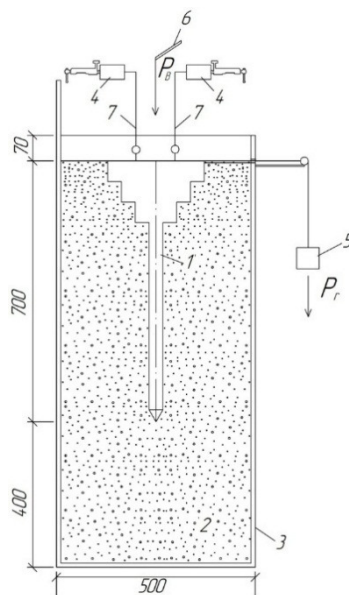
Схема лабораторной установки для испытания ступенчатой сваи: 1 – ступенчатая свая, 2 – грунт, 3 – лоток со стеклянной боковой стенкой, 4 – прогибомер ПСК-МГ4, 5 – груз, 6 – рычаг, закрепленный к лотку для вертикального нагружения, 7 – штатив
